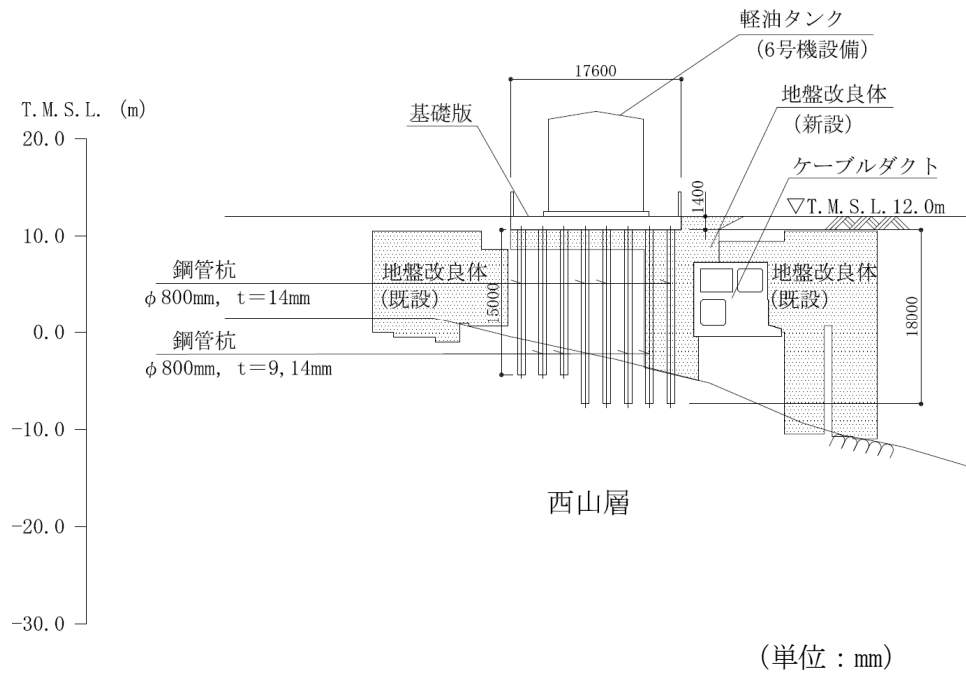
(1) 軽油タンク基礎 (6号機設備) の断面図 (A-A断面)
